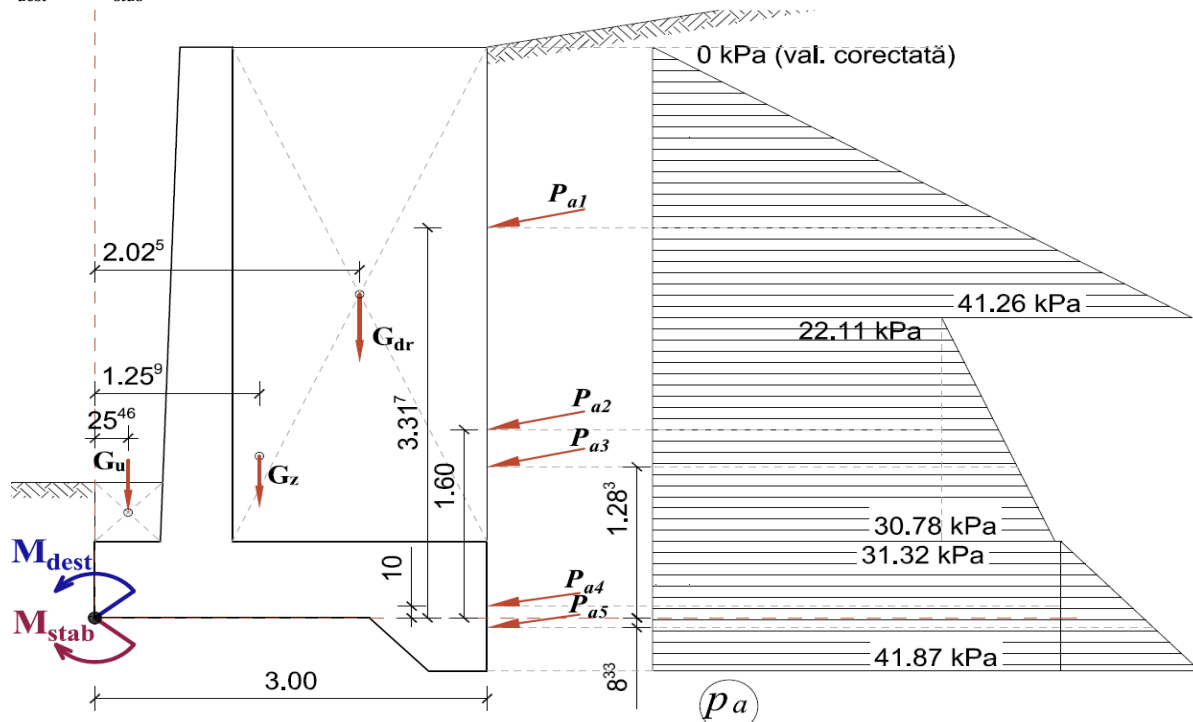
Schema de calcul la verificare la răsturnare (exemplu 2 - zid de sprijin din beton armat)
